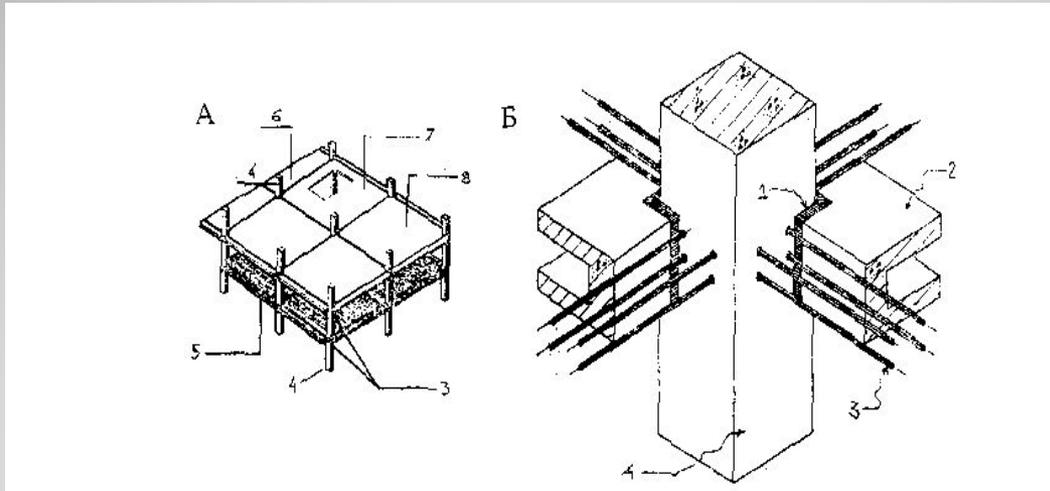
Безригельный каркас с натяжением арматуры в построечных условиях. А – компоновка узла примыкания плит перекрытий и пропуск арматуры через колонну; Б – схема компоновки несущих конструкций; 1 – уголкового вкладыш; 2 – плита перекрытия; 3- натягаемая канатная арматура; 4 – колонна; 5 – фасадная распорка; 6 – консольная плита перекрытия; 7 – плита перекрытия с проемом для лестницы; 8 – типовая плита перекрытия.
